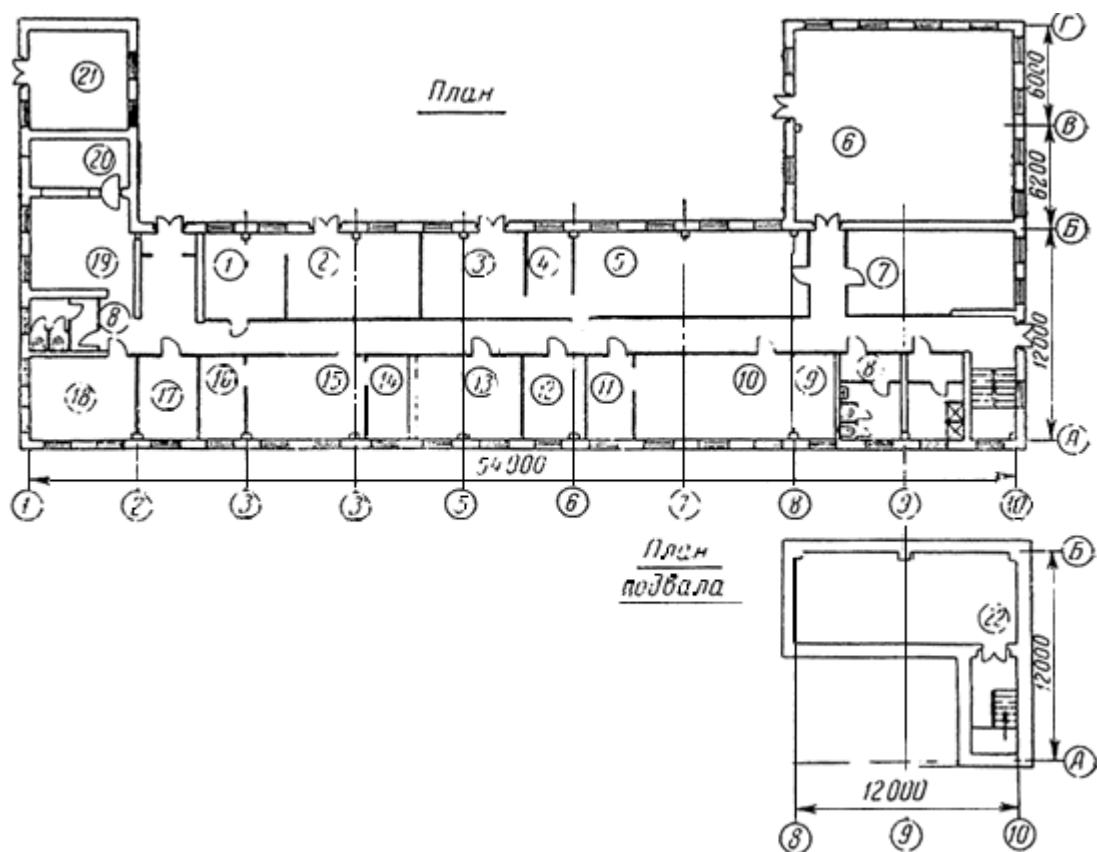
Схематический план помещений лаборатории типа II для строительства гидроузлов с объемом бетонных работ до 1 млн. м³
